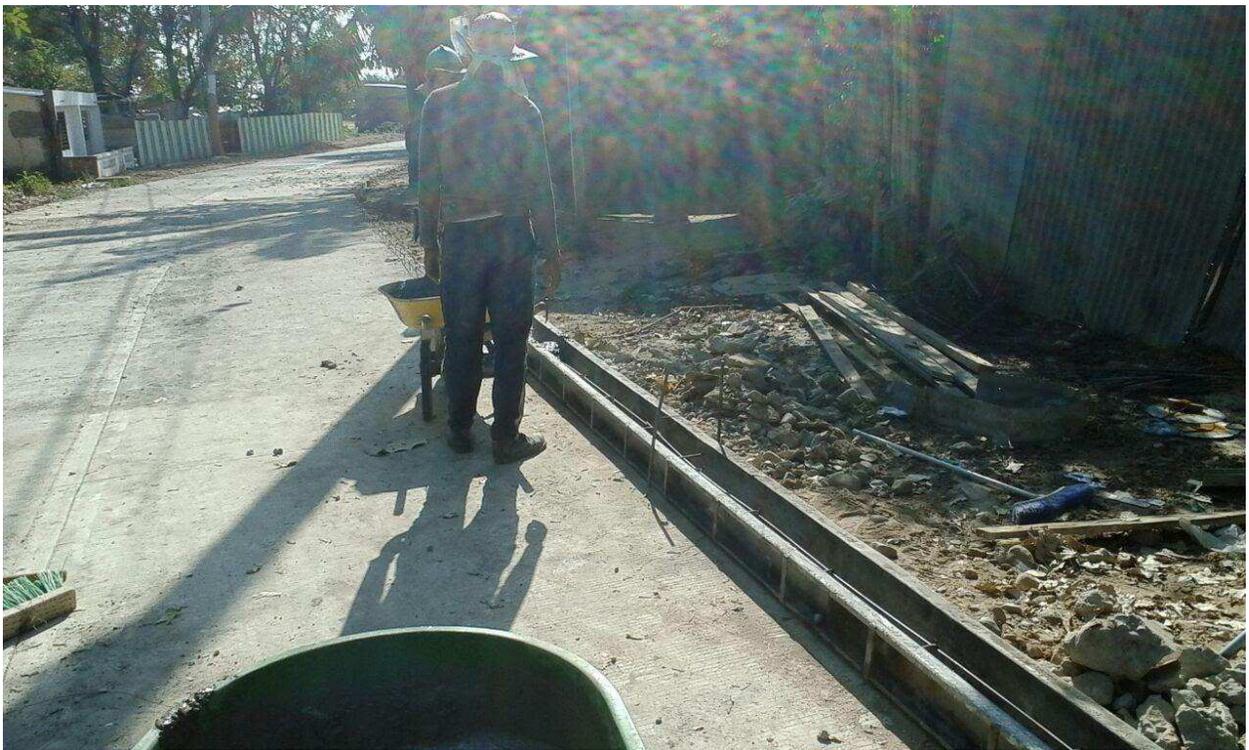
Colocación de formaleta para sardineles calle 9 carrera 6-6^a
